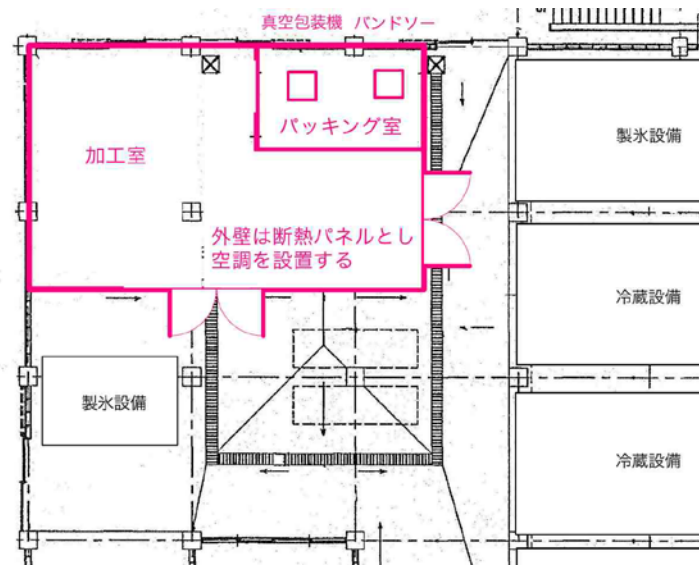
ロゾー水産コンプレックス 水産センター棟1階 漁獲物処理/加工場の平面図
